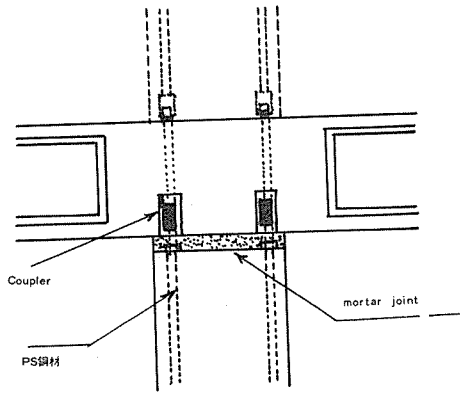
Precast 기둥과 Precast보와의 圧着接合法
